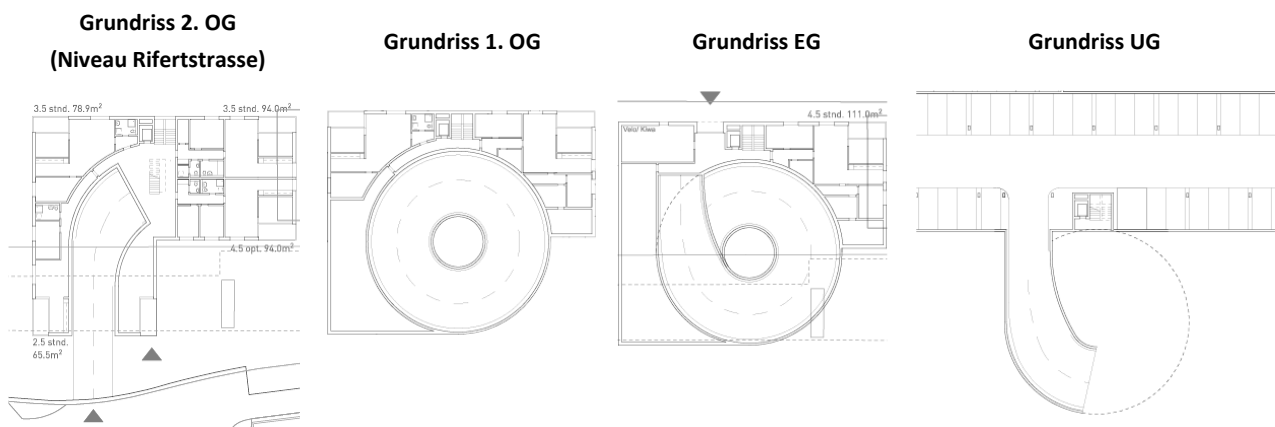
Geprüfte und abgelehnte Erschliessungsvariante ab Wendehammer im Bereich Rifertstrasse 6 und 8, ERP Architekten AG, Baden, Stand Zwischenbesprechung Studienauftrag vom 03.03.2020.
